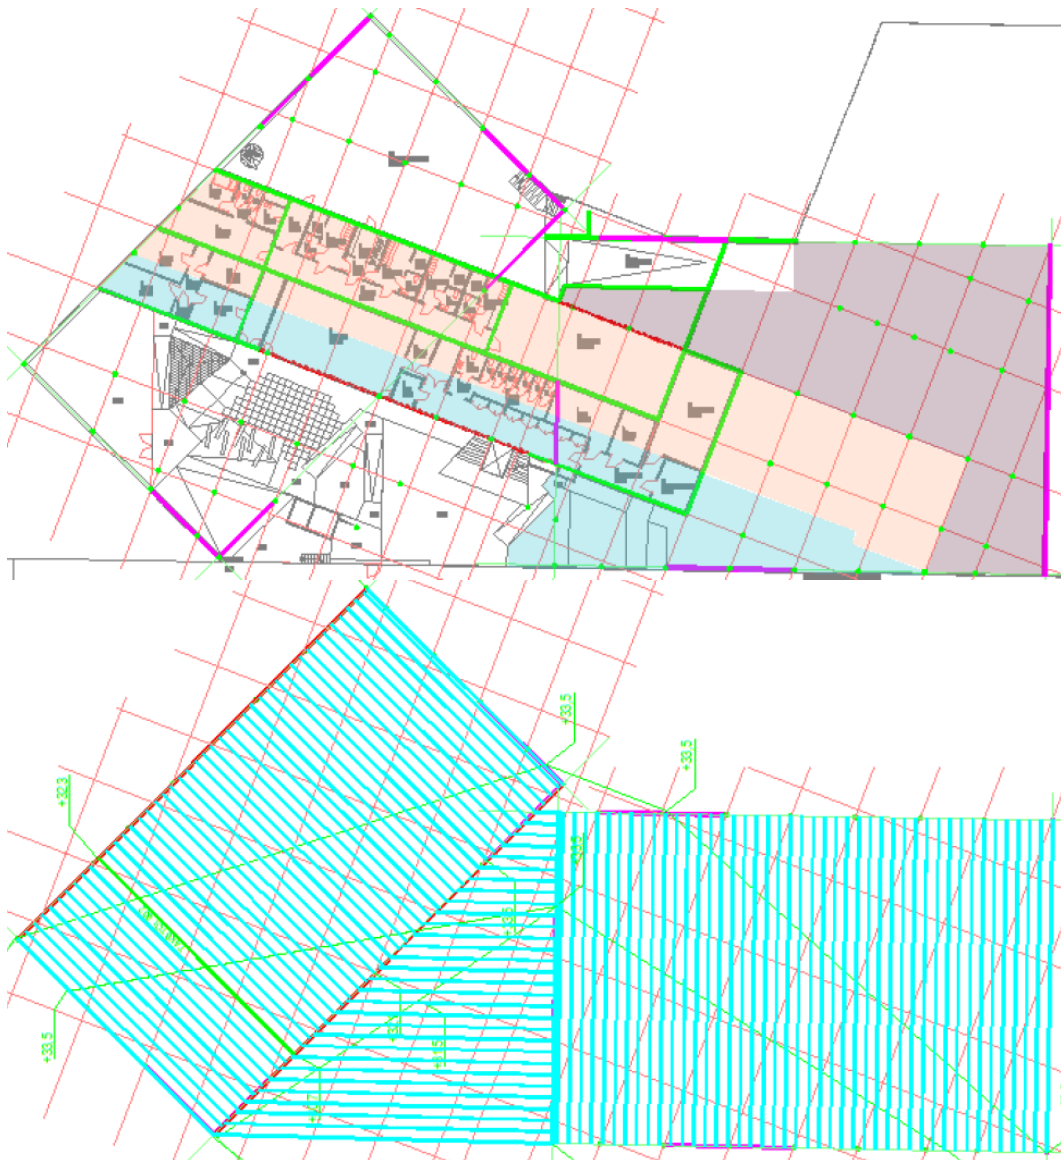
Vy över plan 2 (övre entréplan) och plan 3 (sportgolvsplan).
